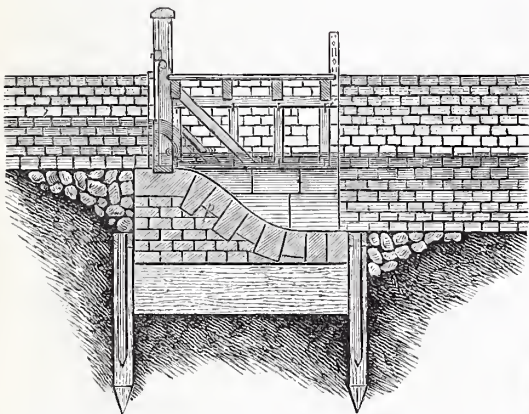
Staueschleuse mit verbesserter Fallmauerkonstruktion.
